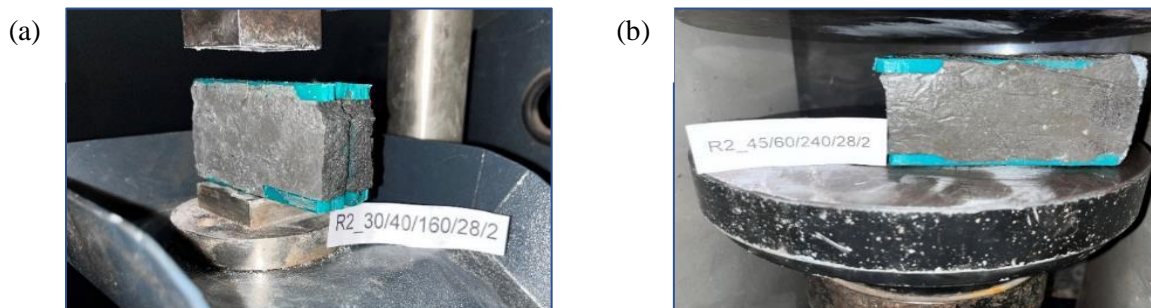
Probetas montadas en máquina de ensayo. (a) R2_30/40/160 y (b) R2/45/60/240.
